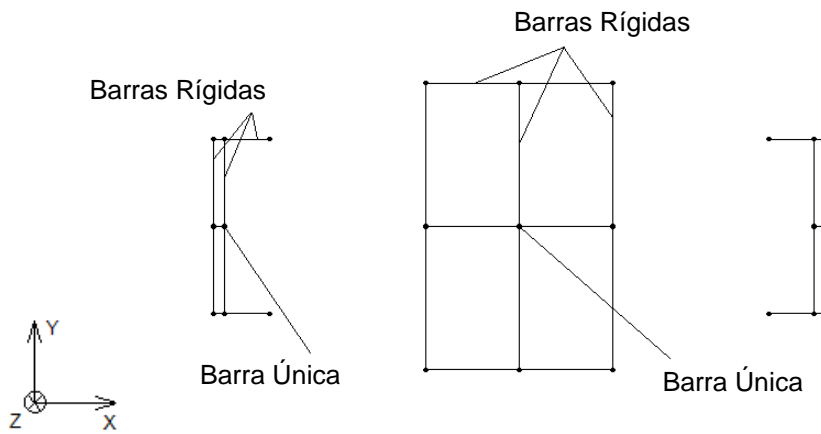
Vista em planta, até ao 37º piso, do núcleo central sem aberturas e dos laterais
